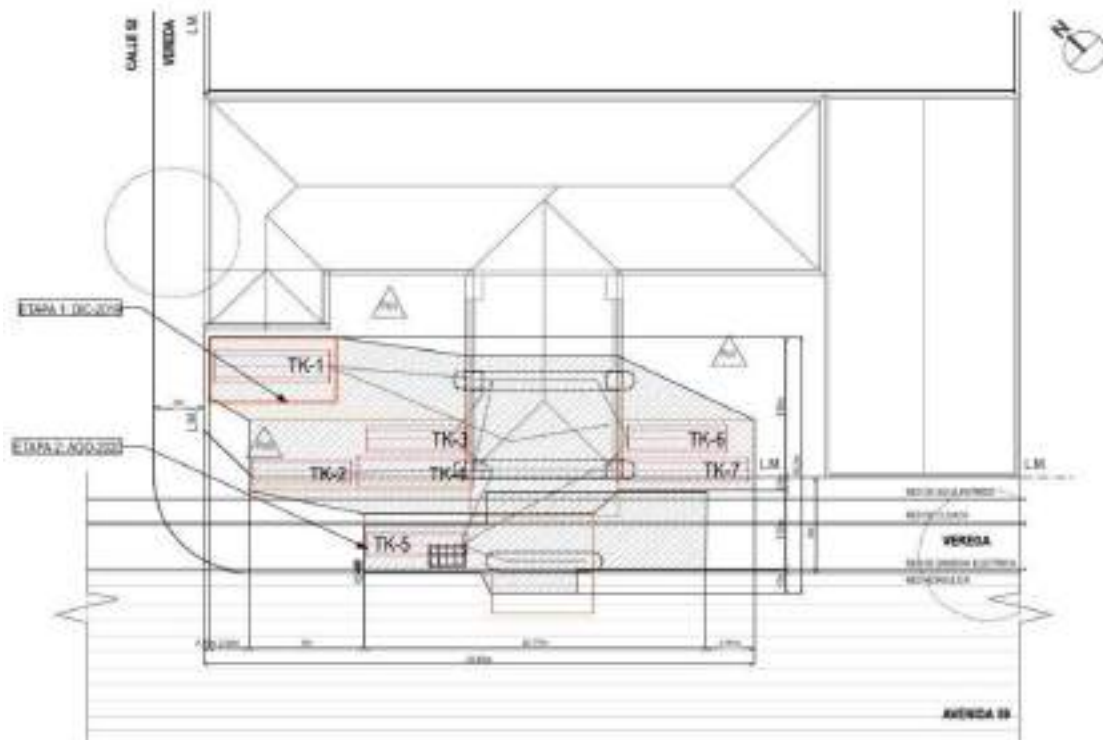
Detalle de la zona excavada (movimiento de suelos). (Fuente: CPC MSaA.)
